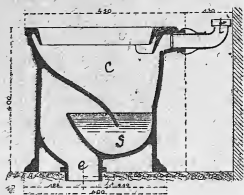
Coupe de la cuvette des cabinets à chasse.
